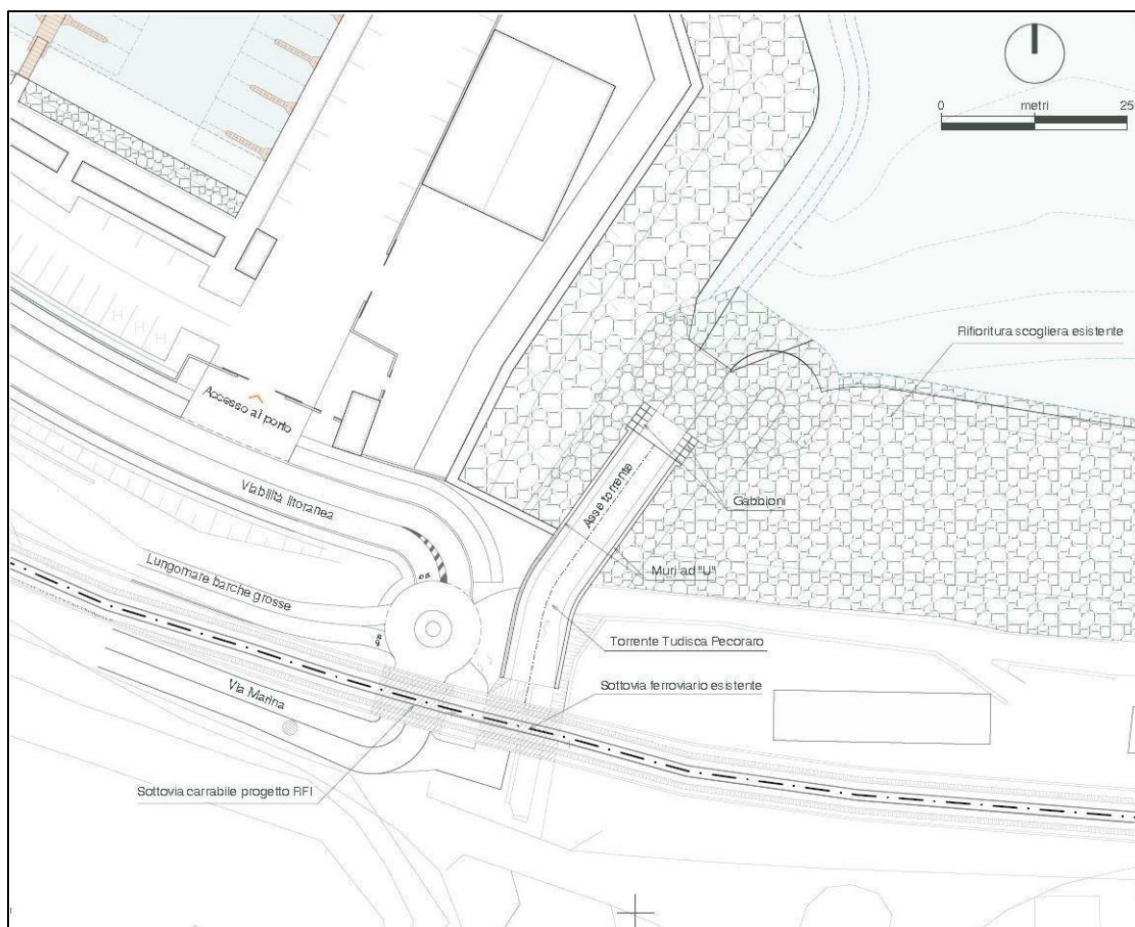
Vallone Tudisca - soluzione di progetto – Planimetria assetto finale della viabilità.
